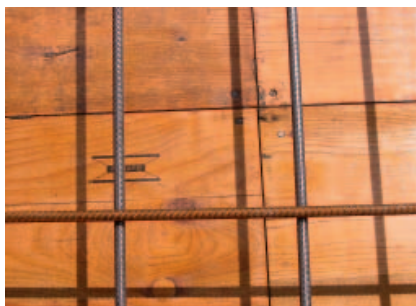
Exemple de joint étanche (pas de bavure de mortier fin)
